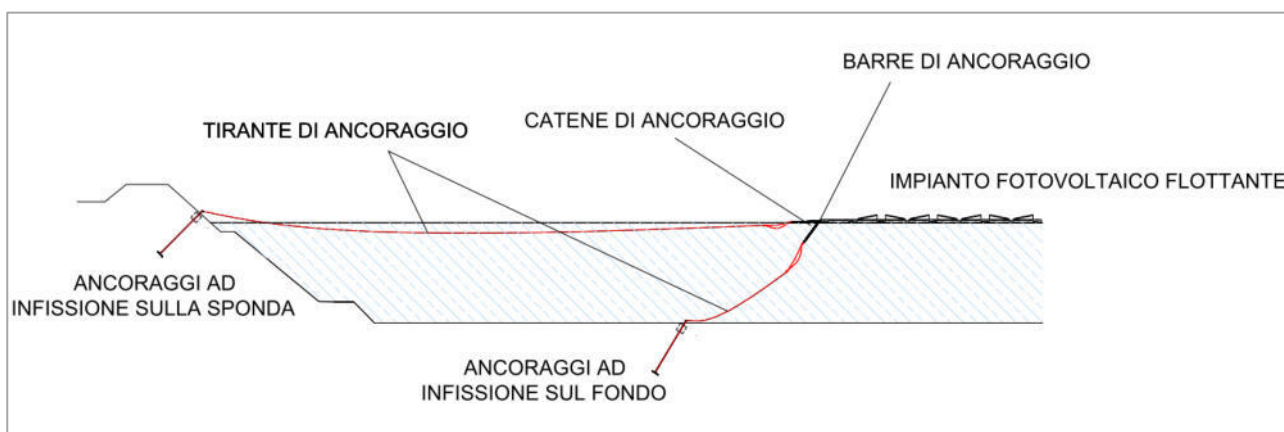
Sezione tipologica con sistemi alternativi di ancoraggio ad infissione
